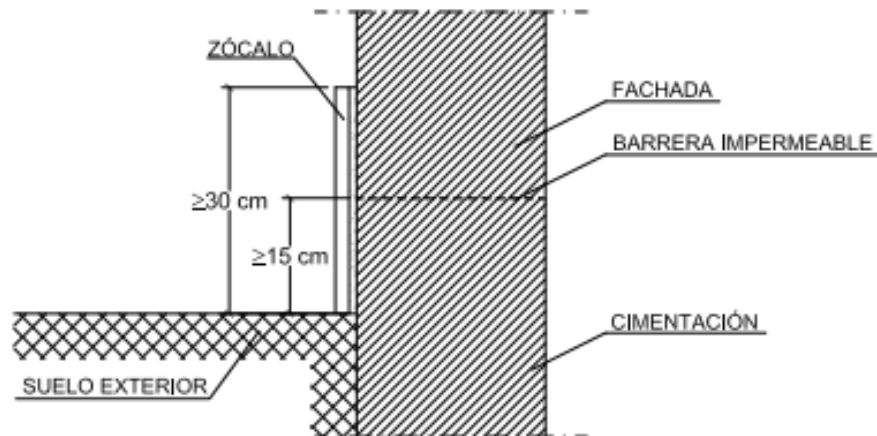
Ejemplo de arranque de la fachada desde la cimentación
